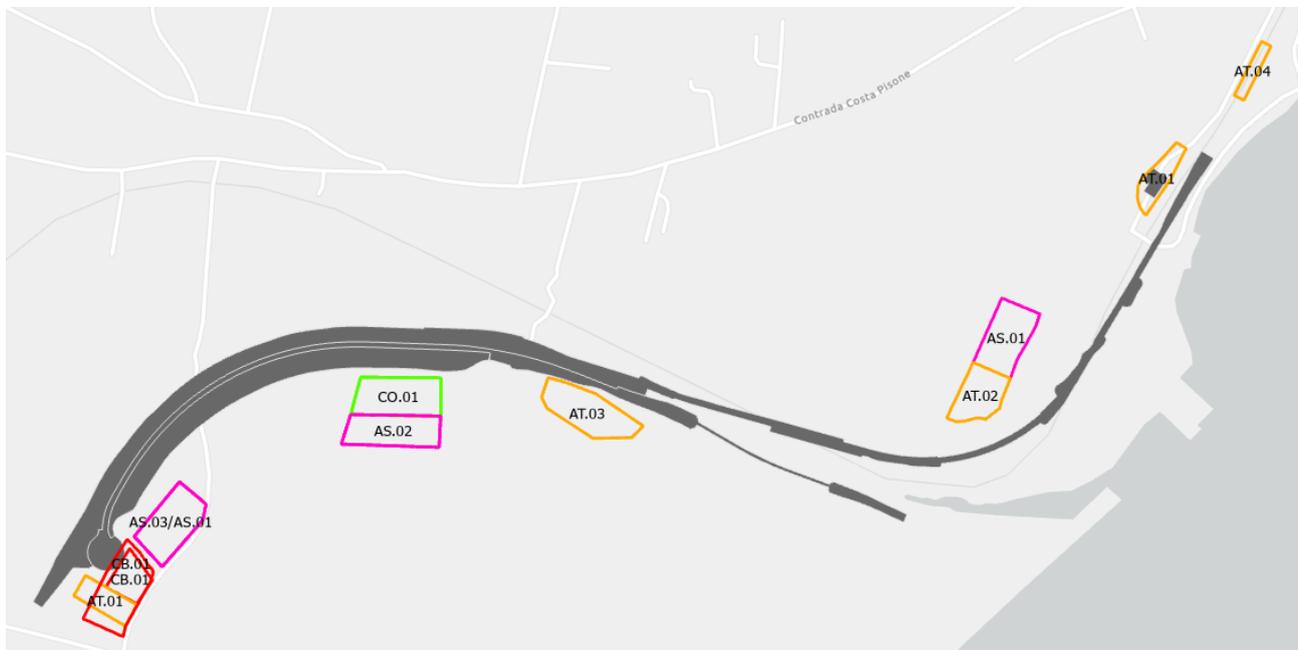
Stralcio planimetrico ubicazione cantieri in rapporto all'opera
